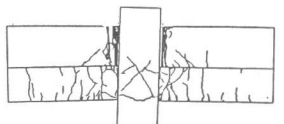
No.8(圧縮せん断型目地) 最終ひび割れ状況
